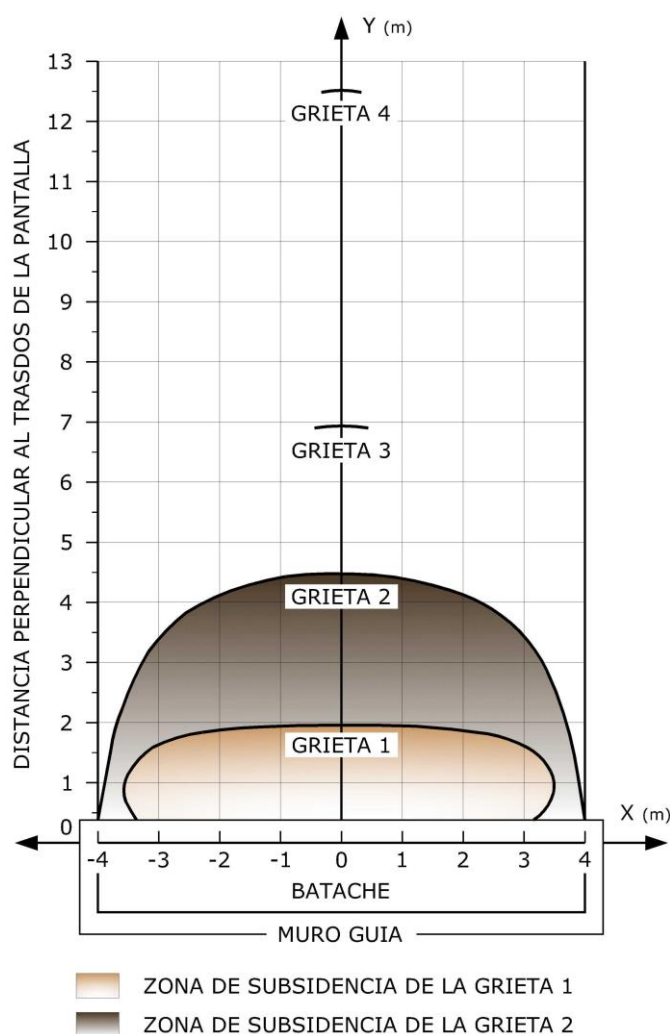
Esquema de planta de generación de grietas en el trasdós de la pantalla (Tsai *et al.*, 2000).
